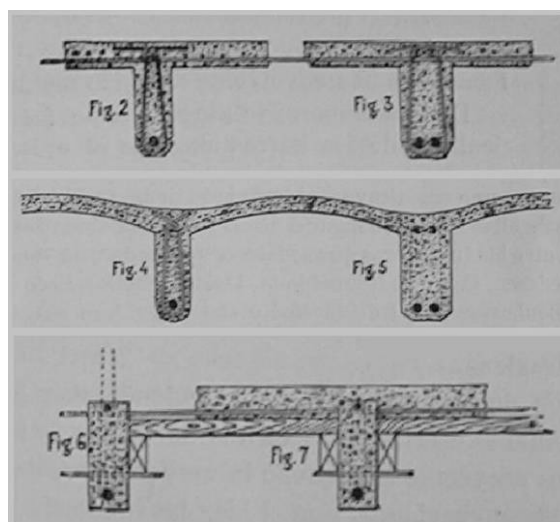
Diversas soluciones de armado de vigas. Ribera, 1902.
